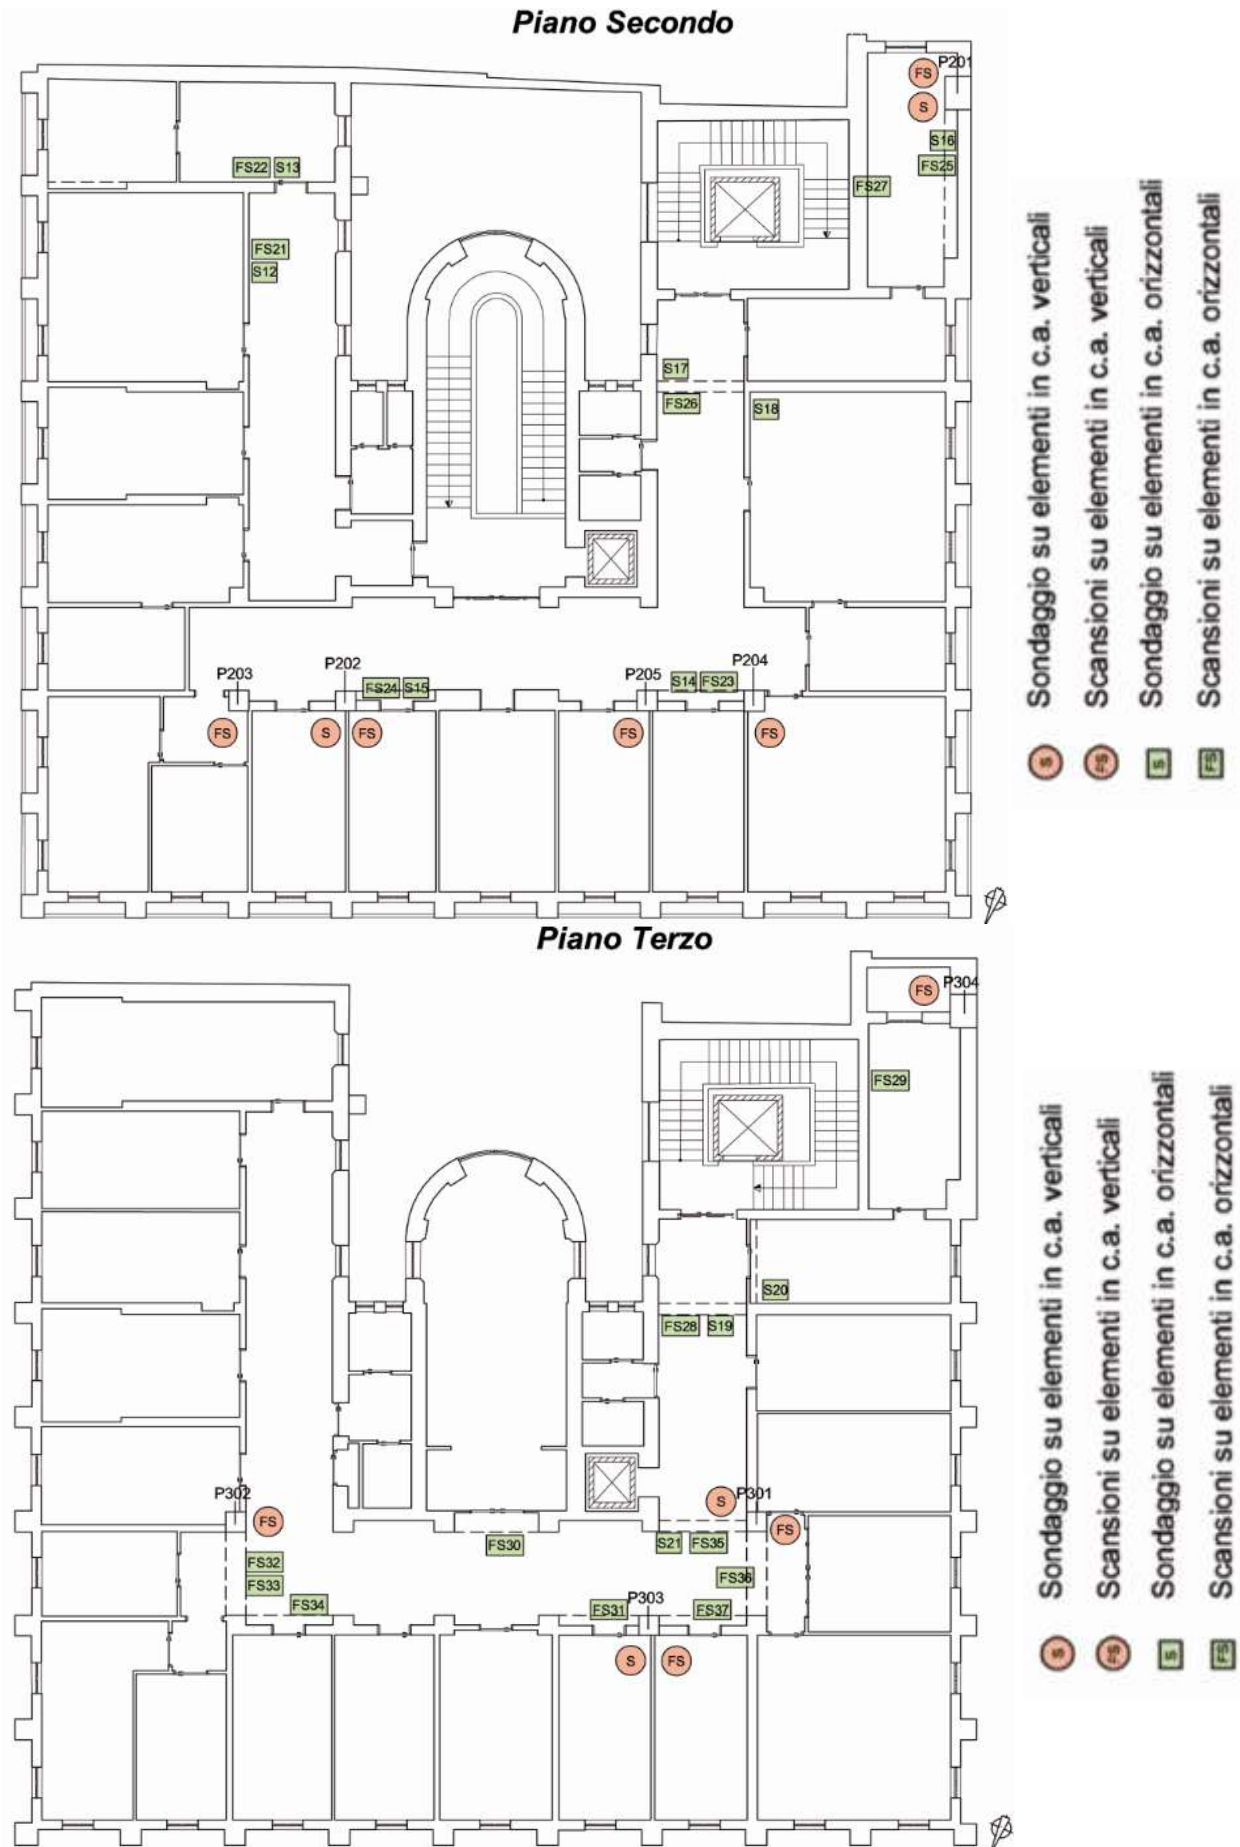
Pianta chiave con indicazione dei punti di sondaggio sugli elementi in c.a. ai piani secondo e terzo.
